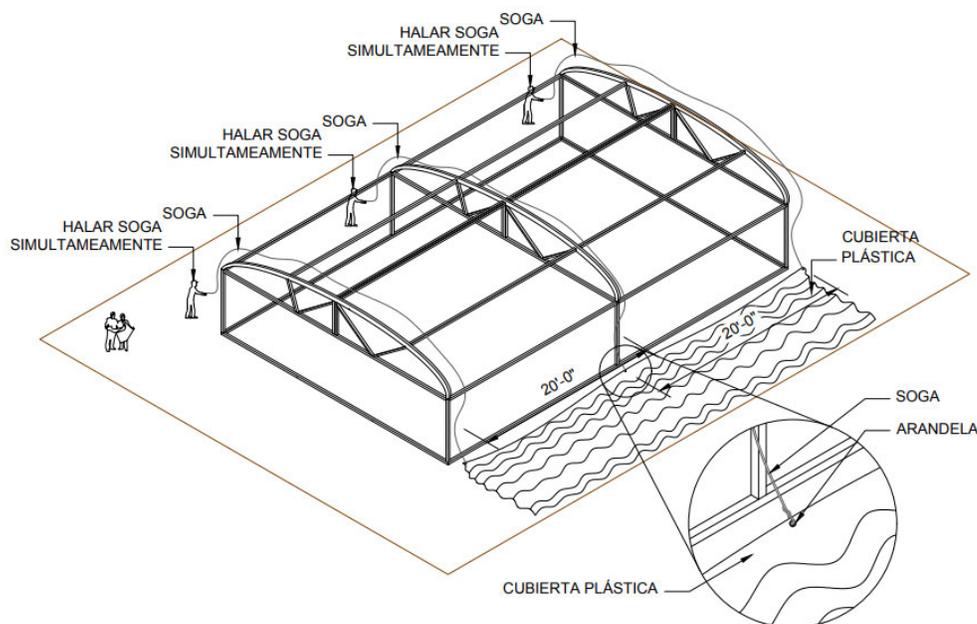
Esquemático de la instalación de una cubierta plástica
